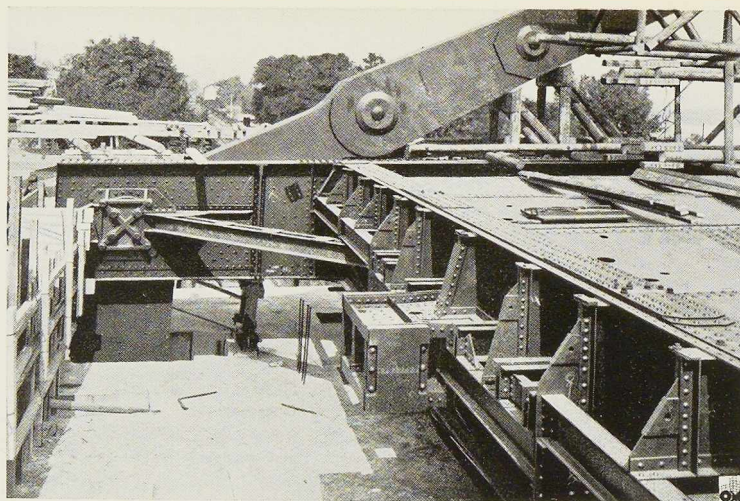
Chaîne de retenue, chaîne d'ancrage et poutres de contreventement.
